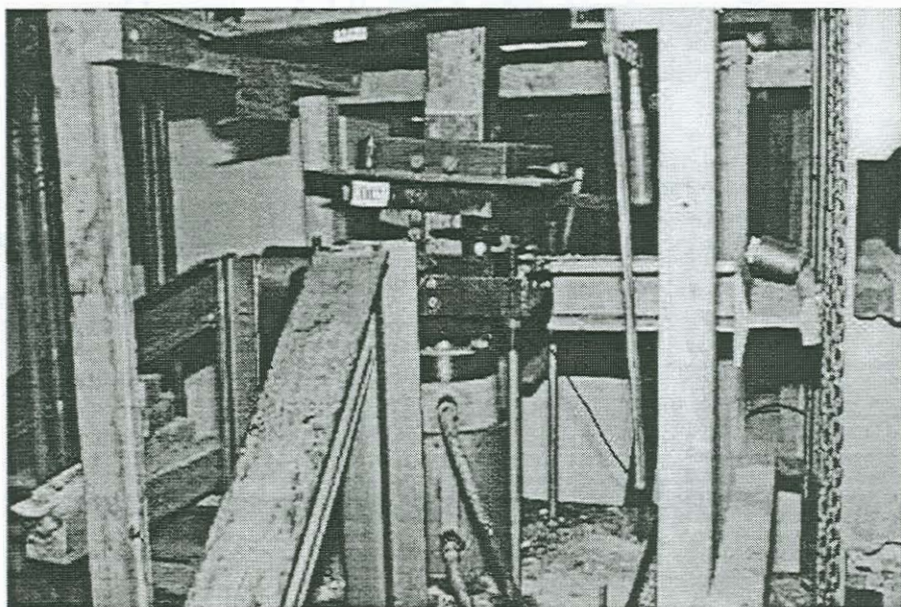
Sistema de carga, apoio inferior e contraventamento.
